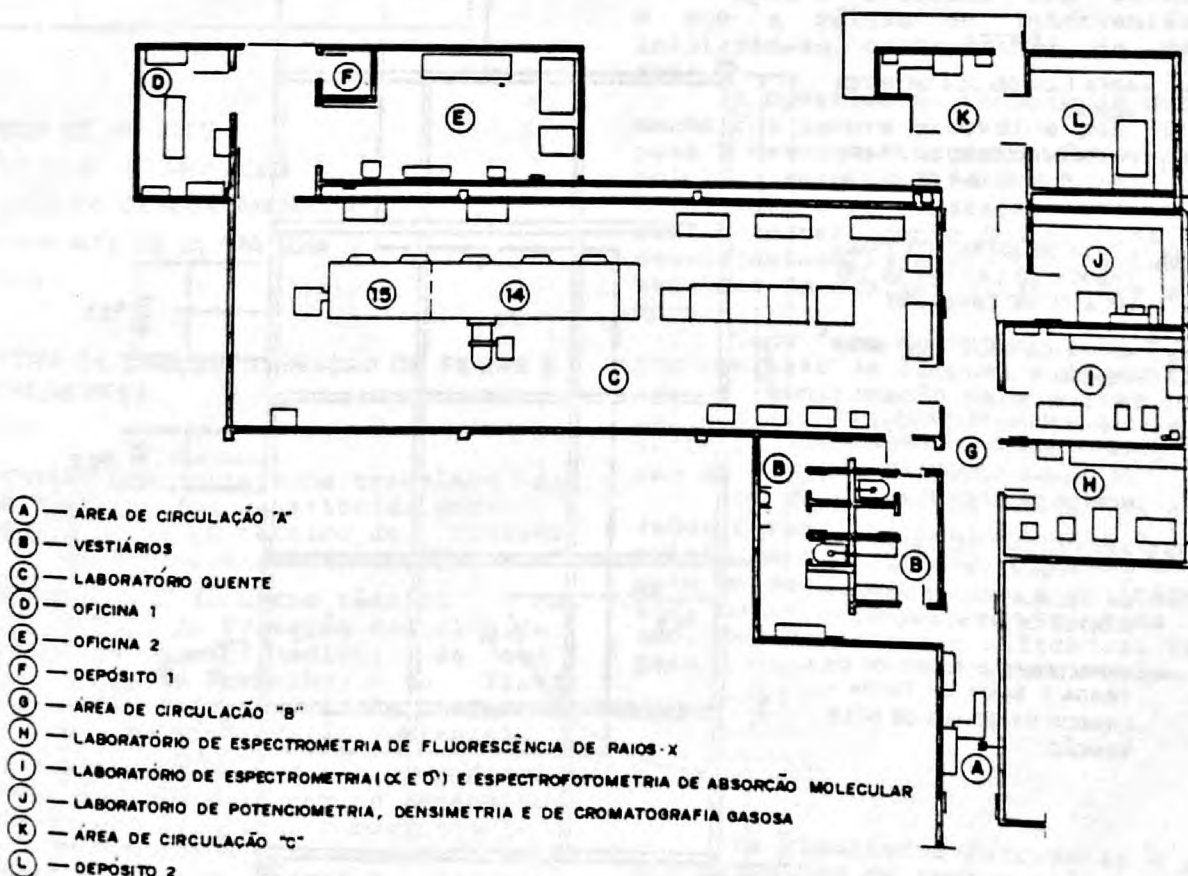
LAYOUT DA INSTALAÇÃO CELESTE I.
